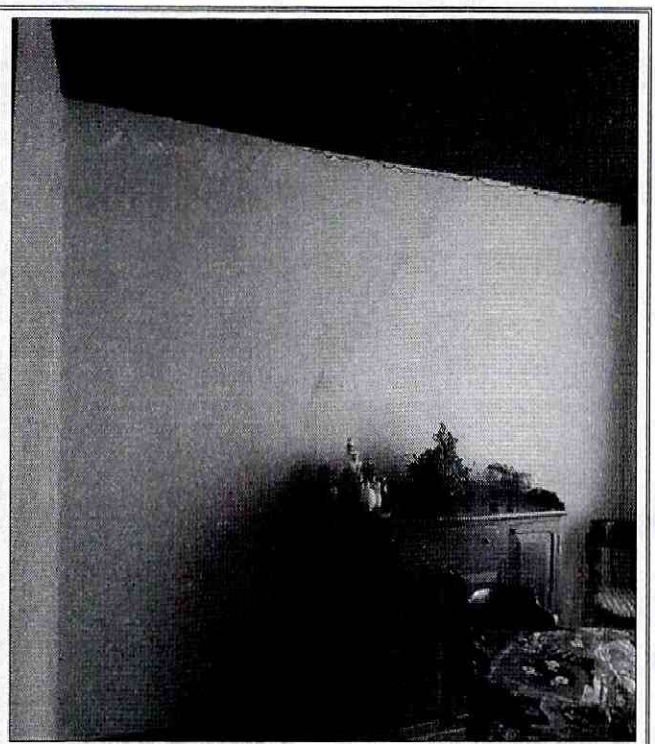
Grietas identificadas en muros de cerramiento y divisorios de la vivienda ubicada en el predio de la Calle 104 No. 58 A – 12, en el Sector Catastral Puente Largo de la Localidad Suba.
